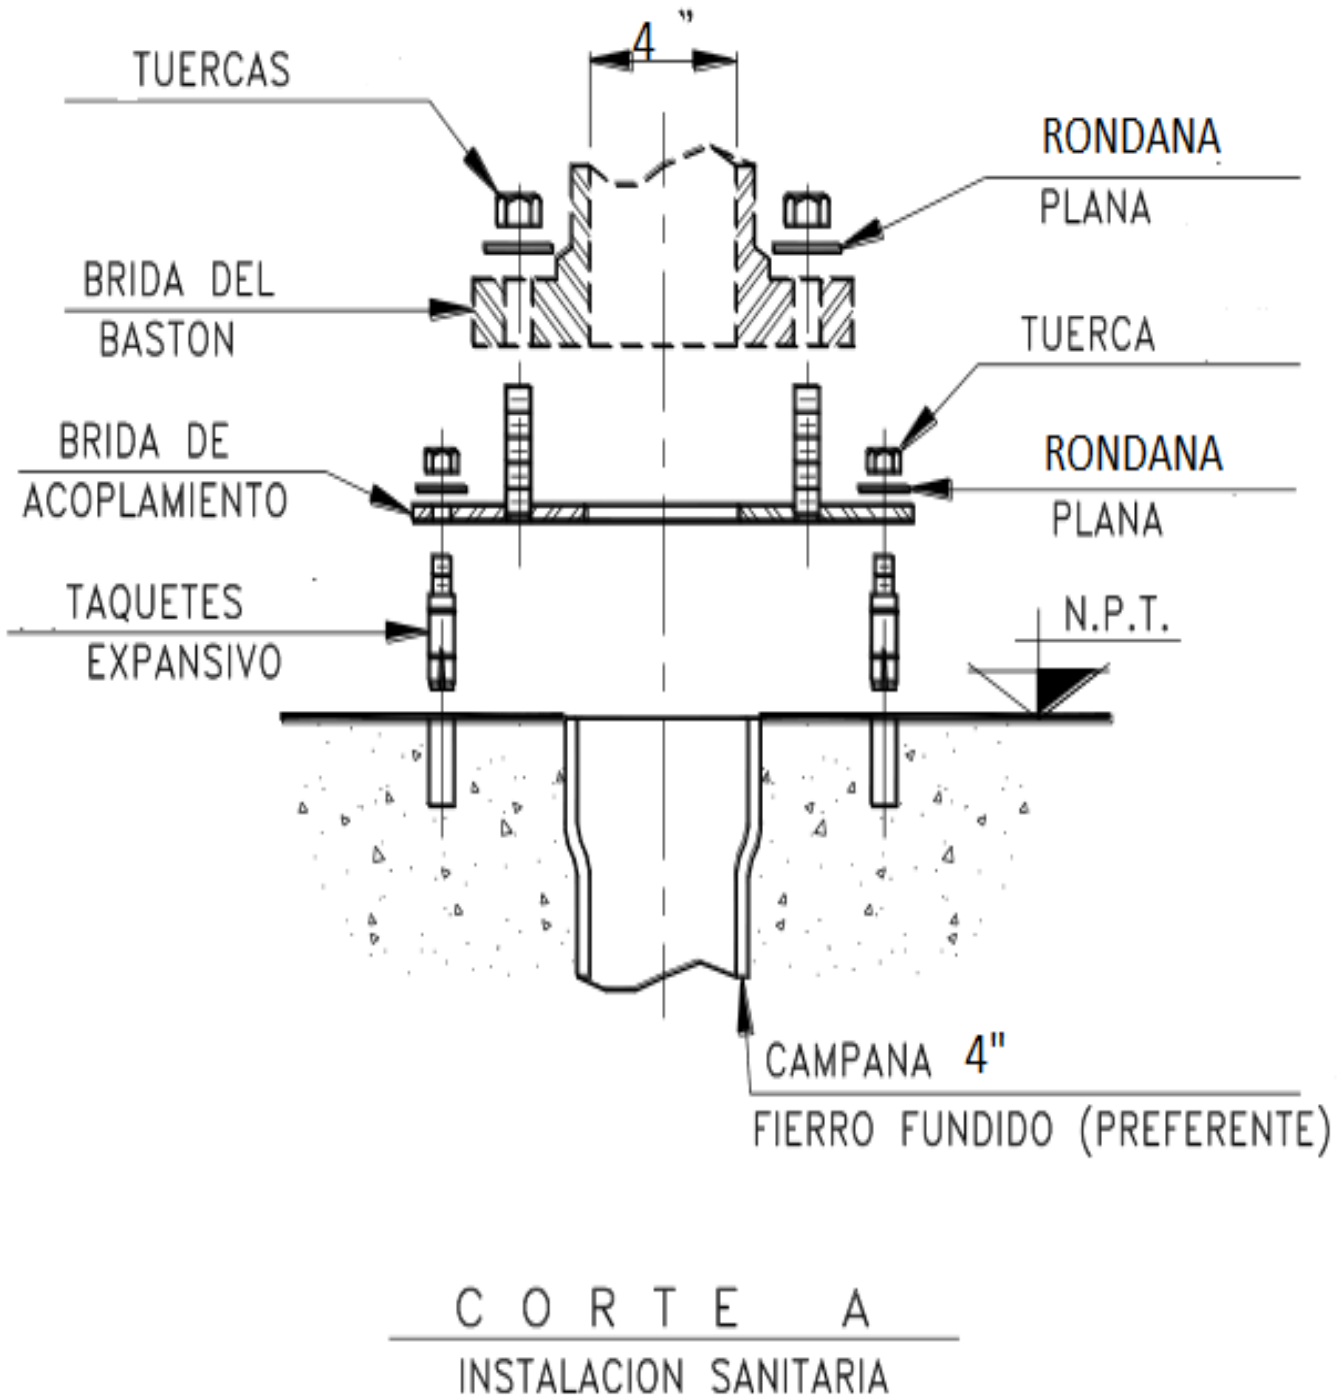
Vista de corte de instalación sanitaria brida sobre piso terminado
